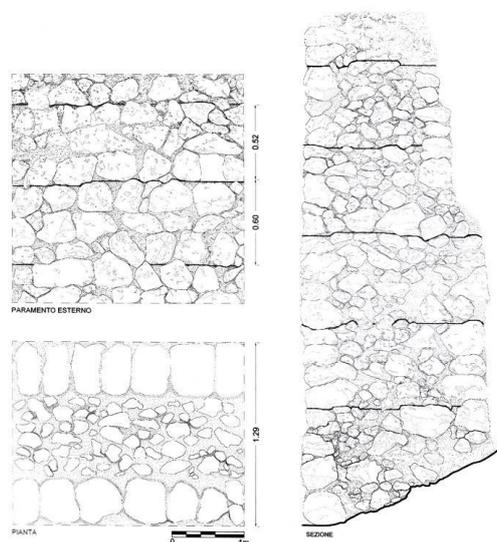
Cagliari, Tour Sant'Elia. Détail de la surface extérieure, du plan et de la section. Le dessin met en évidence le système 'à chantiers', visible en prospectus et en section (restitution graphique M. Porcu).
